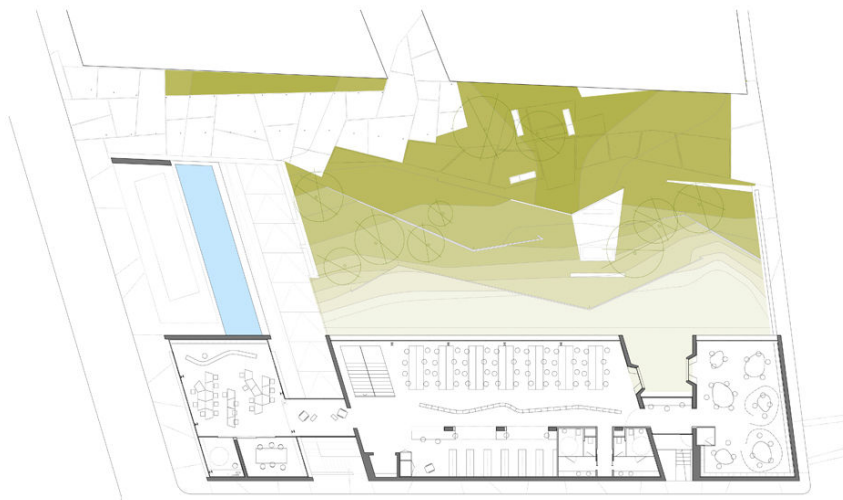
Planta segundo pavimento (DIEZ, 2009)
